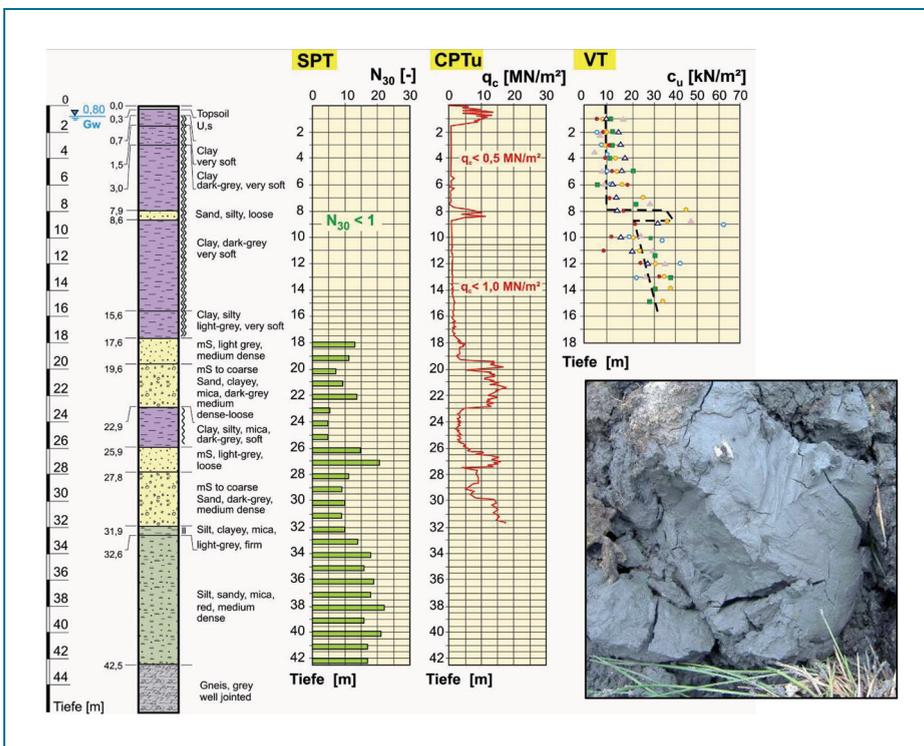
Typische Baugrundaufschlüsse im Bereich des Stock Yards (Rohstofflager).
